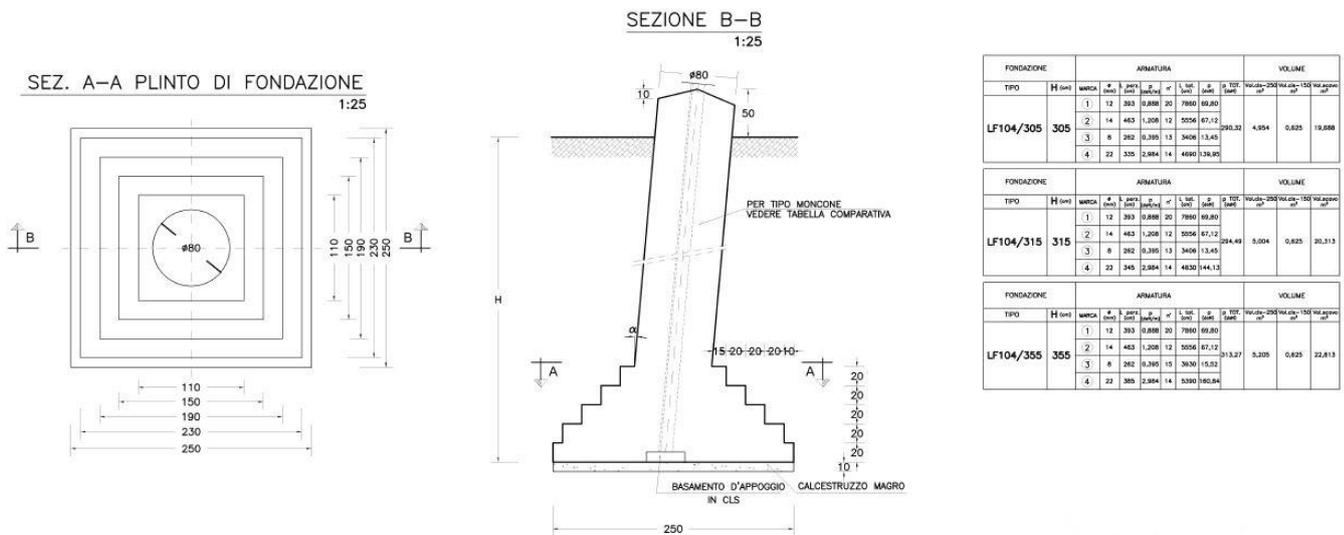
Fondazione a plinto con riseghe tipo per palo di sospensione doppia terna
